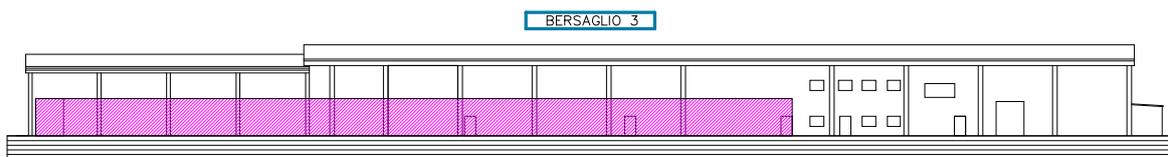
Determinazione delle piastre radianti sul piano radiante 3.
